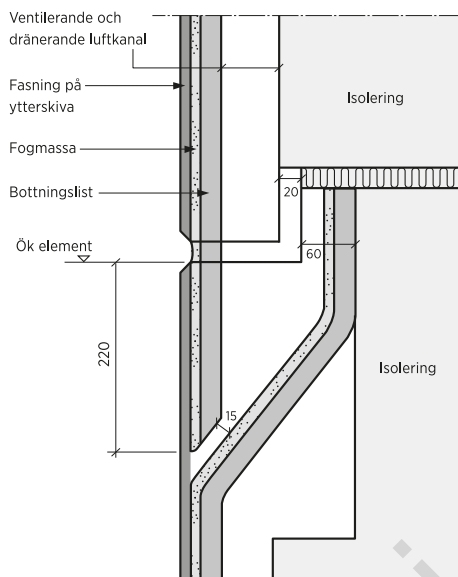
/2. VERTIKALSNITT UTFORMNING OCH PLACERING AV ÖVERLAPPANDE FOG VID DRÄNERINGSRÄNNA I ÖVERKANT AV BETONGELEMENT.
